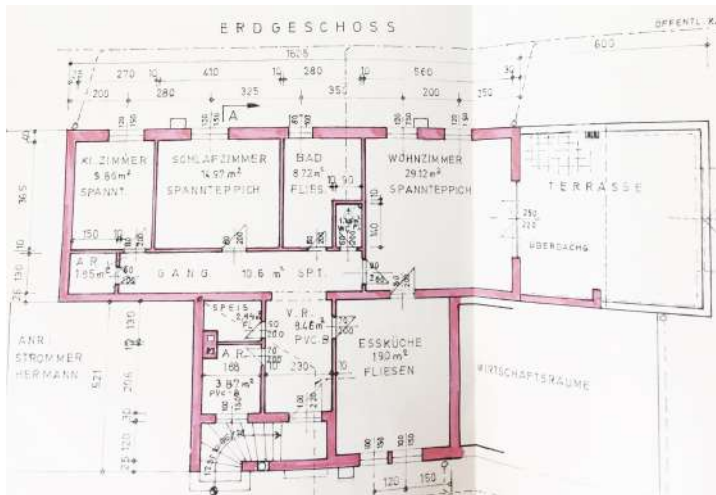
Grundriss der zusammengefügte Streckhöfe, 1990
